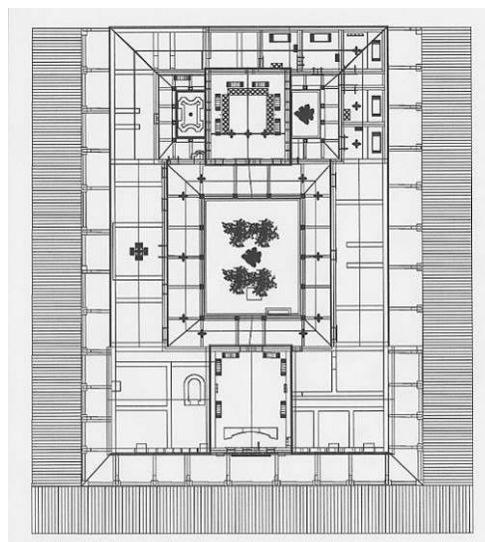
Hipótesis de planta Casa de los Pájaros.
